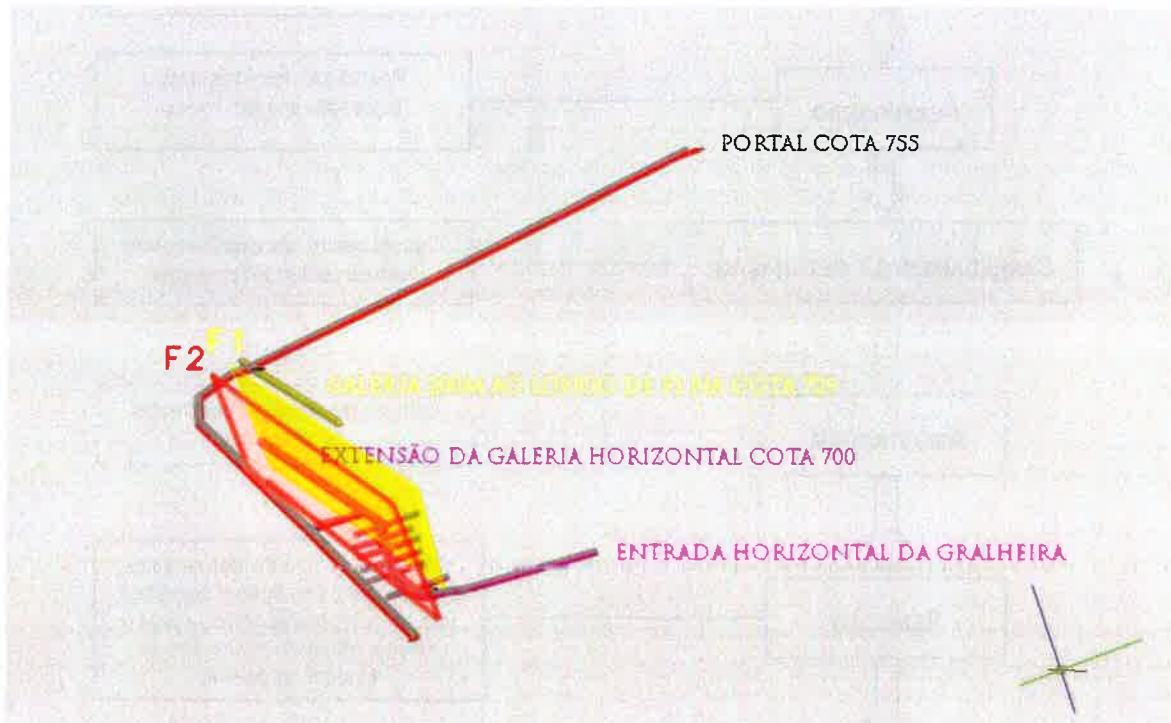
Vista 3D de SE da galeria RAMAL a amarelo e da curva da Rampa de Acesso Norte a acompanhar as estruturas mineralizadas F1 e F2.
